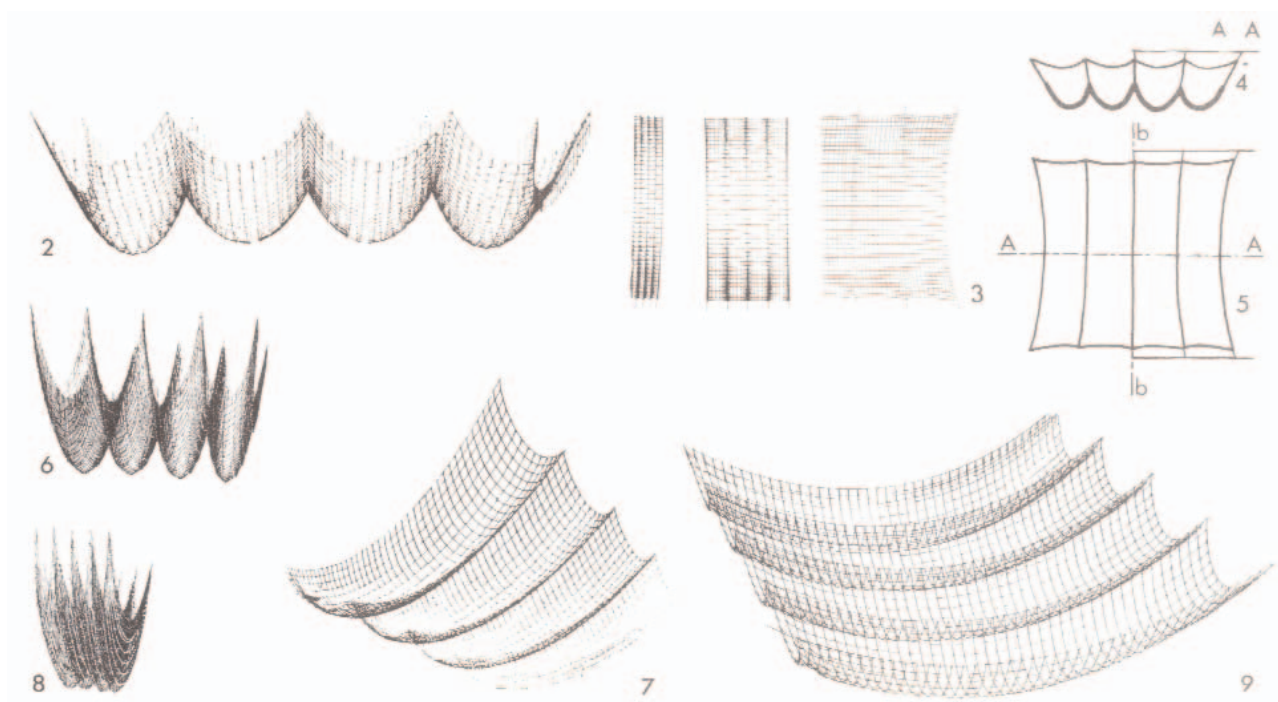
Red con bordes flexibles y aristas abiertas adicionales y flexibles. Fuente: IL 10 pág. 95
